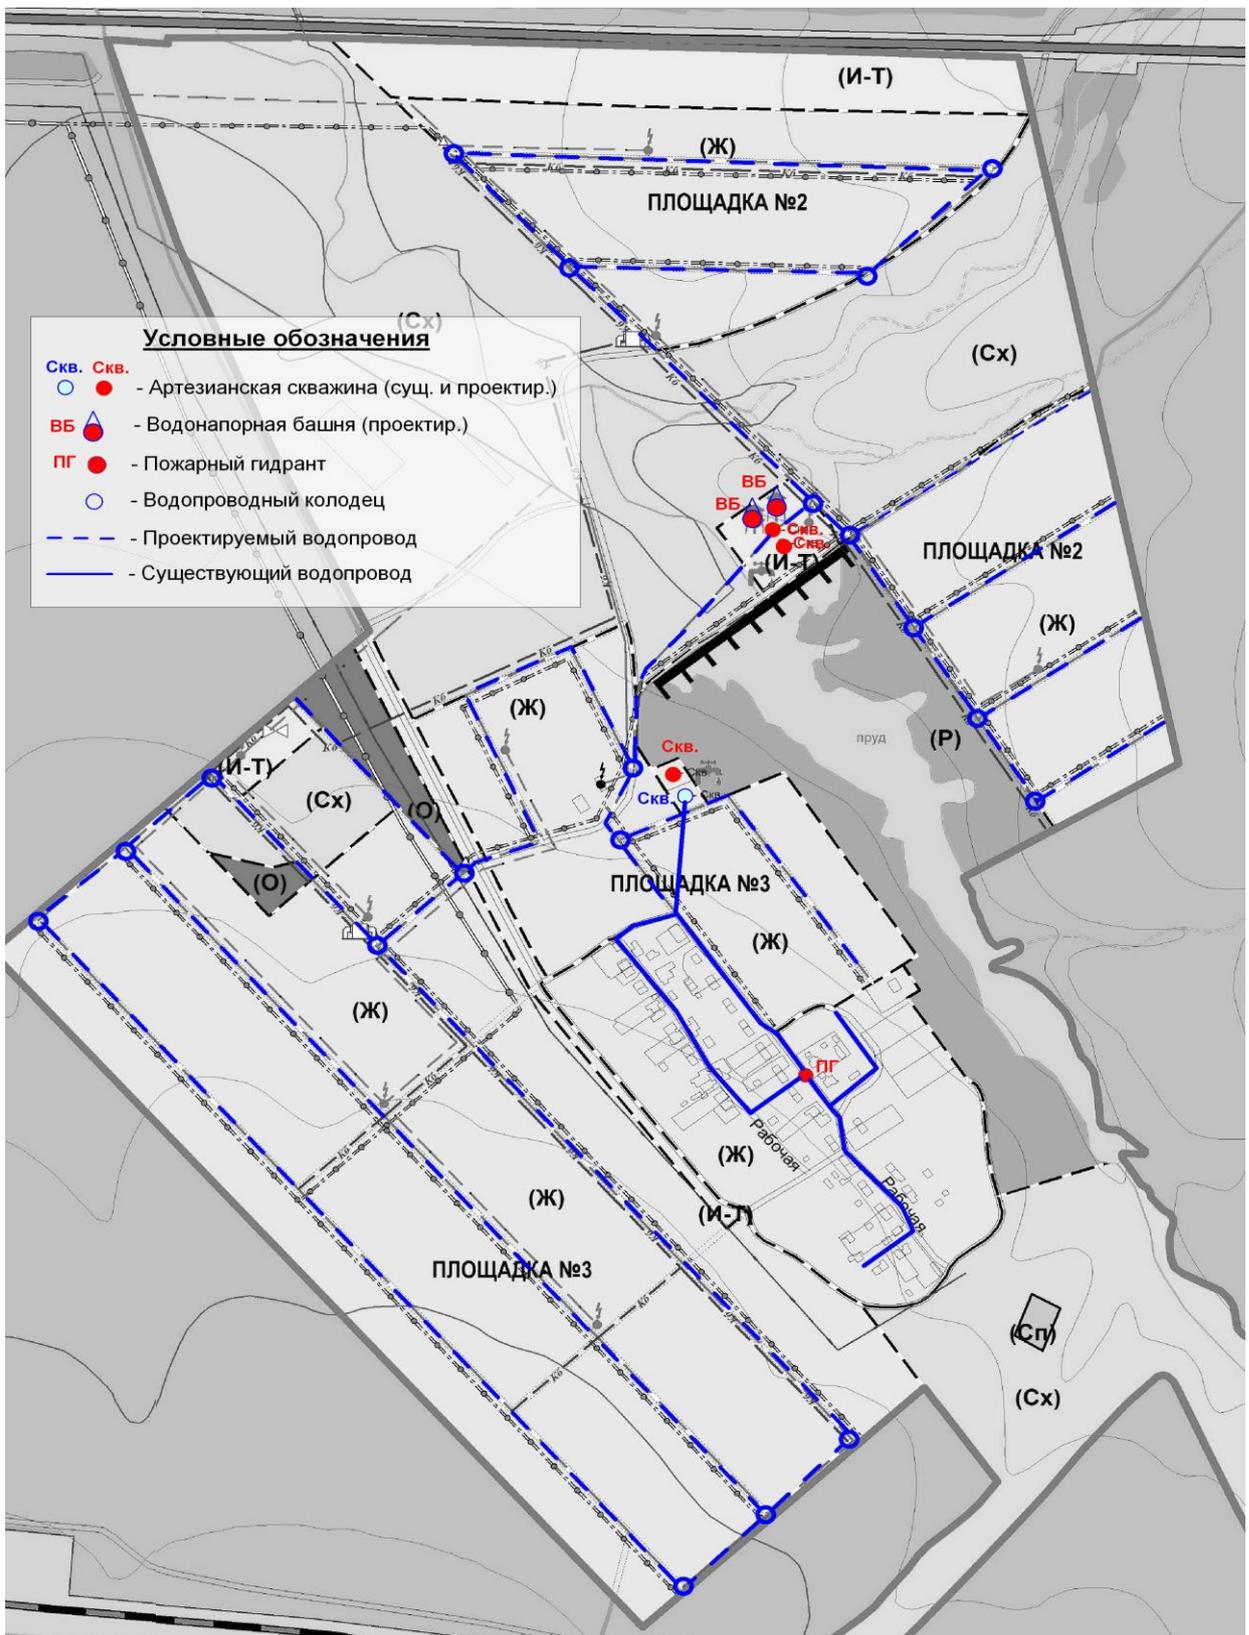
План развития водопроводных сетей п. Новые Озерки
